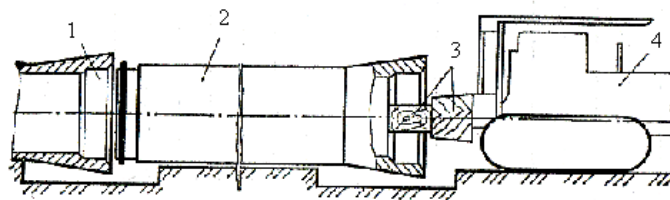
Îmbinarea tuburilor cu ajutorul buldozerului 1 – tubul montat; 2 – tubul în montare; 3 – bîrne din lemn; 4 – buldozer (tractor)
